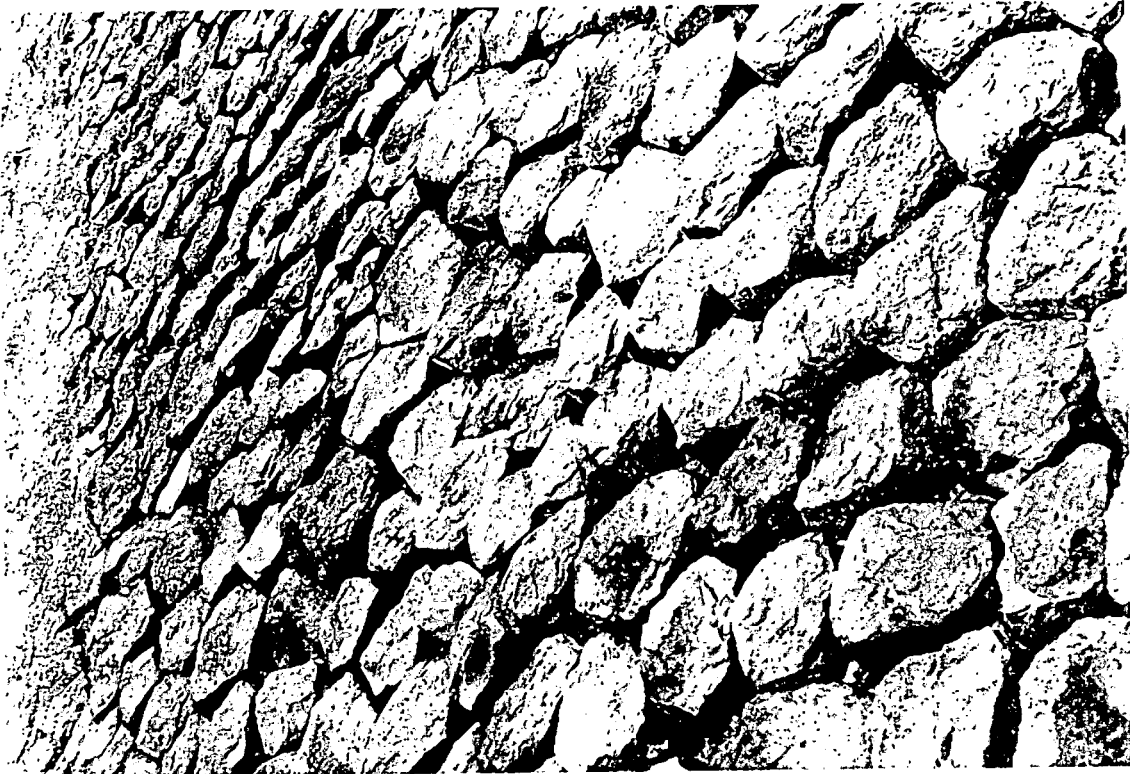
Westelijke locatie: sterk gekantelde blokken, met hier en daar verzakking
